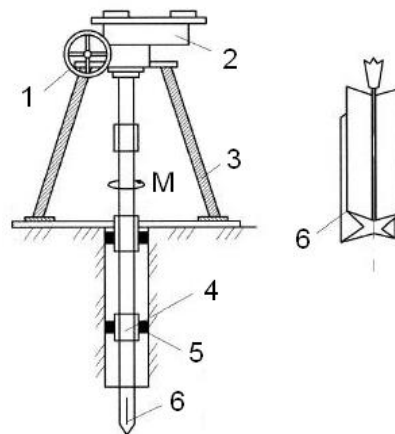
Схема установки обертального зрізу: 1 – кермо; 2 – вимірювальний прилад; 3 – станина; 4 – штанга; 5 – центруючий пристрій; 6 – крильчатка
